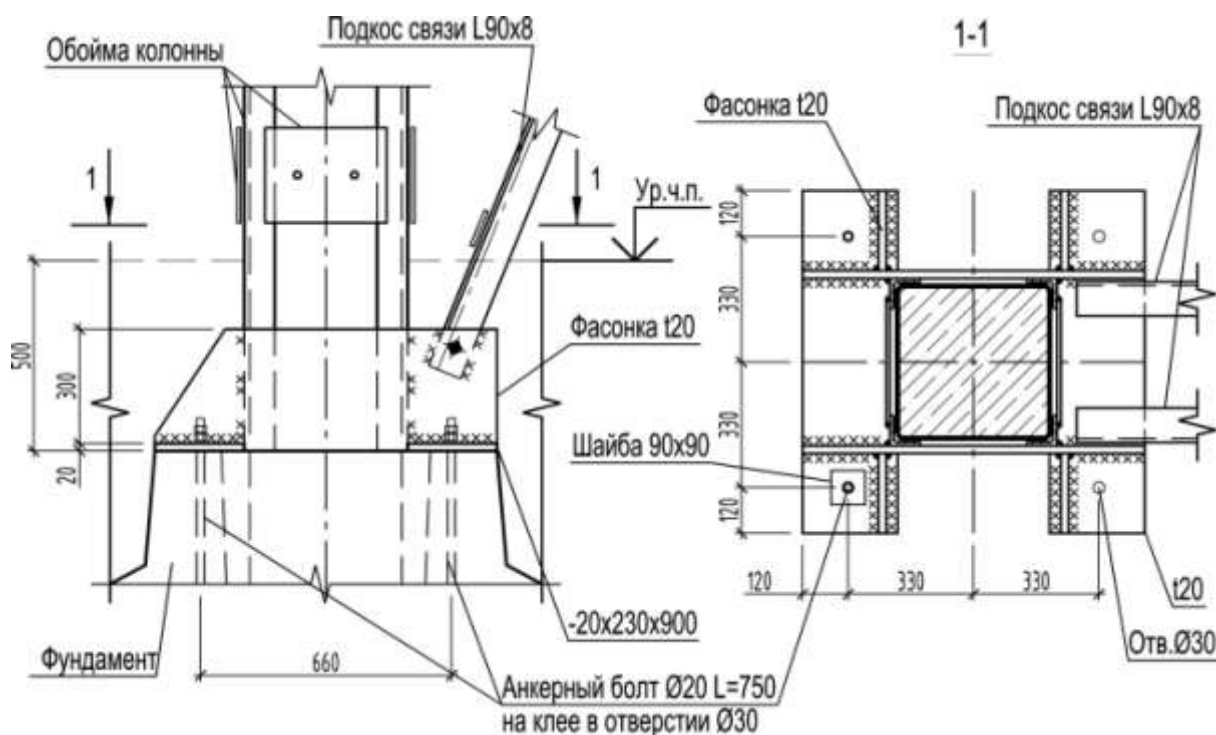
Крепление подкоса стальных связей к фундаменту
